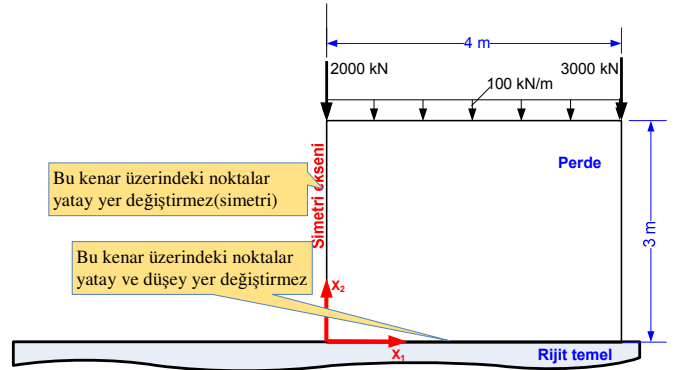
de görülen, 8x3 m boyutlu ve 0.25 m kalınlığındaki betonarme perde rijit temele oturmaktadır. Beton sınıfı C25/30 dur. Levhaya etkiyen yükler üst yapıdaki kolonlardan, duvara ve döşemelerden gelmektedir. Bu yüklerden perdede oluşan σ_{11} , σ_{22} ve σ_{12} gerilmeleri hesaplanacak ve bazı kesitlerdeki dağılımları çizilecektir.
